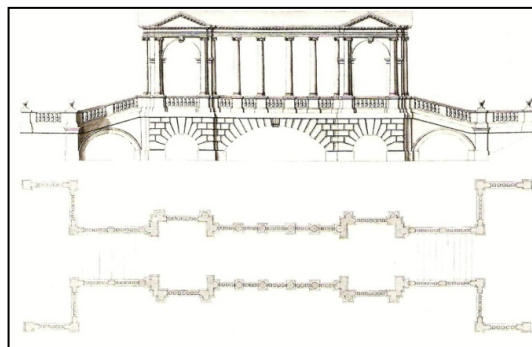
, Planta e Alçado da Pembroke Bridge em Wilton, Wiltshire, c. 1771.
